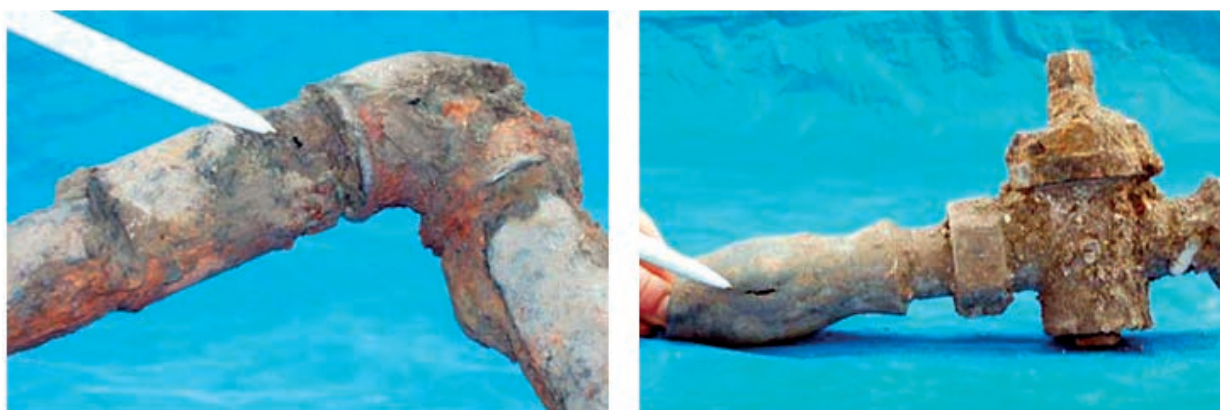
Schaden an einer Hausanschlussleitung; links: Durchrostung; rechts: Längsriss in einer Bleirohrleitung
